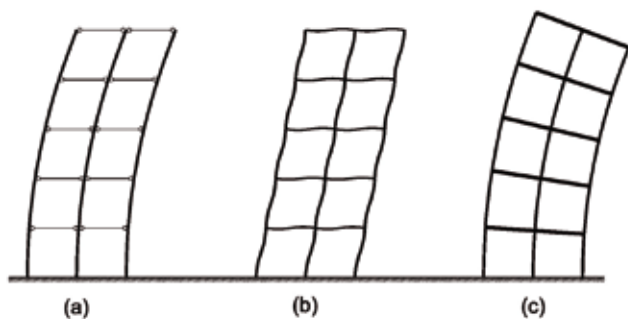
Deformación de una estructura pórtico ante acciones laterales en los casos: a) vigas de rigidez despreciable; b) vigas de rigidez normal; c) vigas muy rígidas
